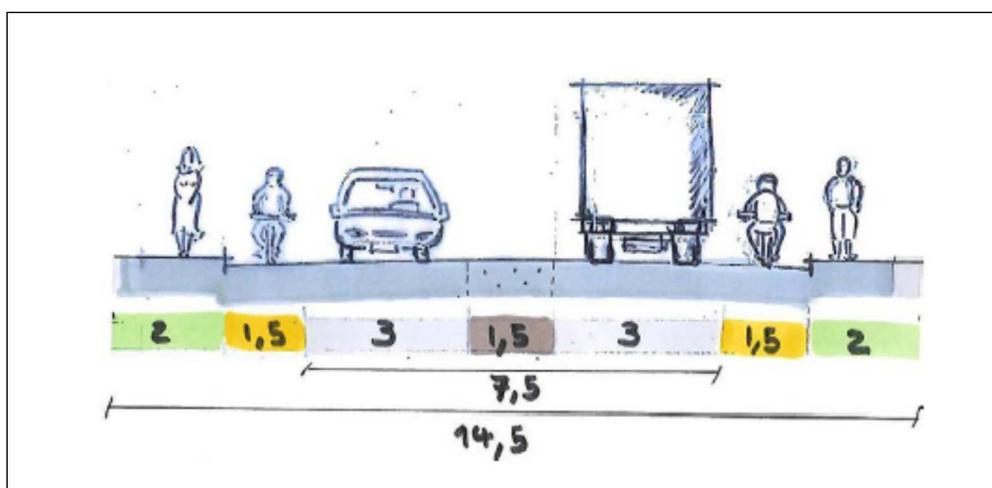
Gabarit minimum en section (en mètres) sur la RC 1 en traversés de localité
